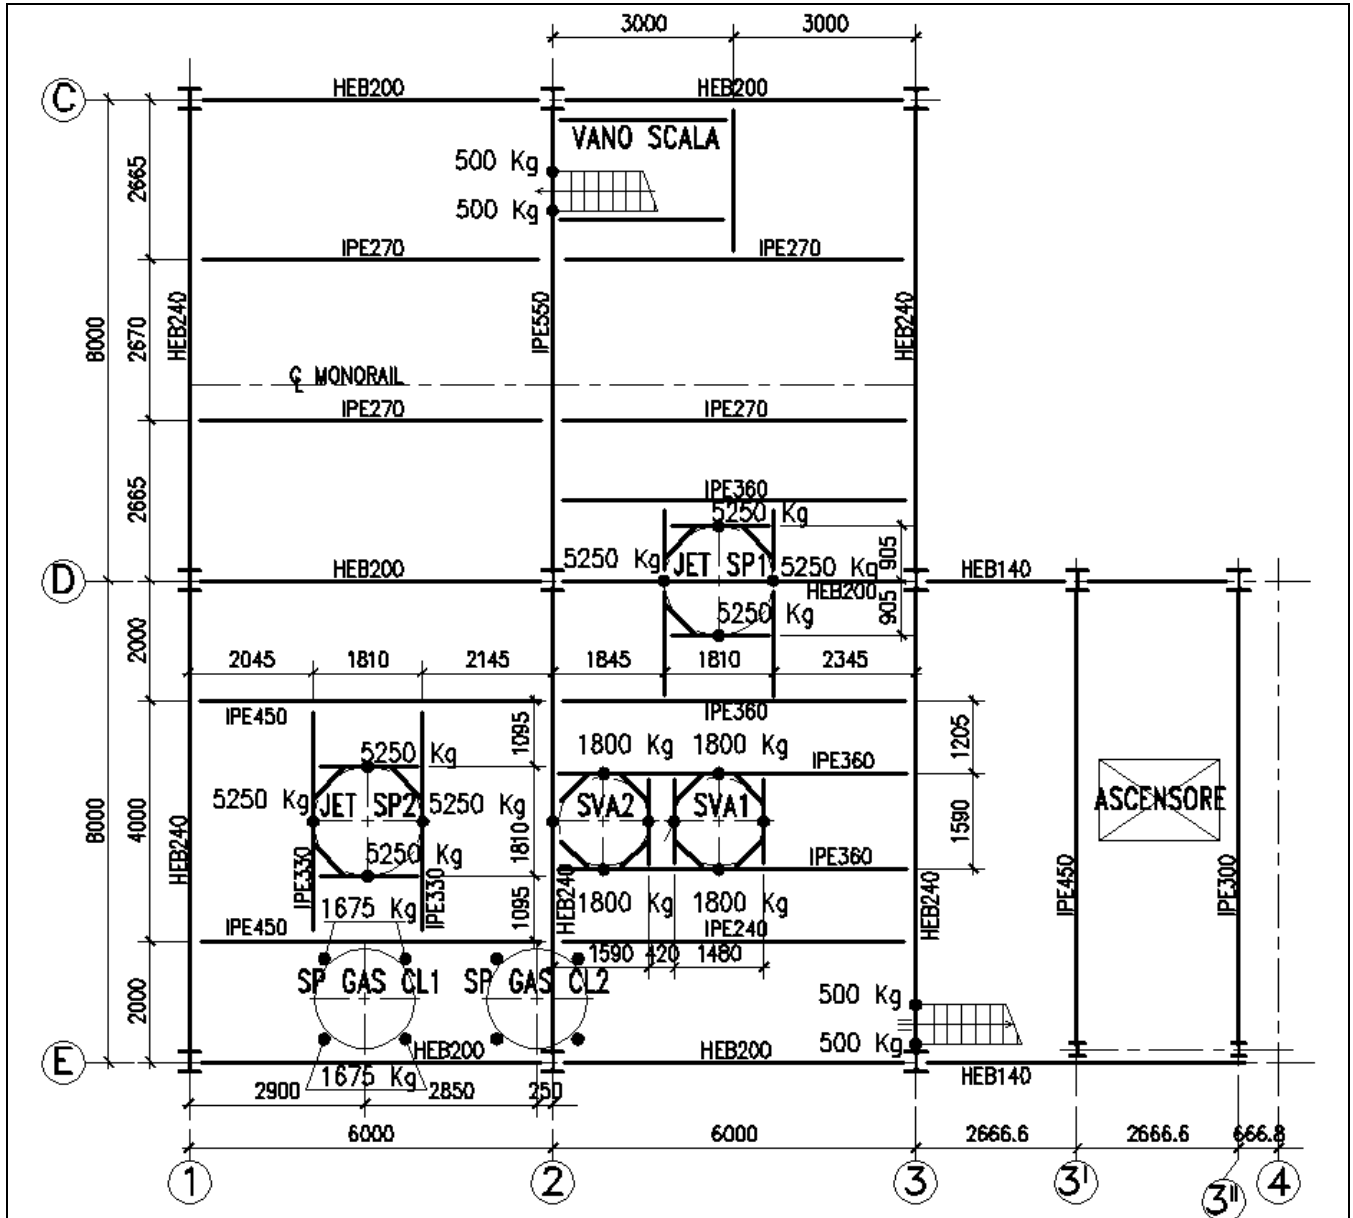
PLANIMETRIA +30.800 - sesto impalcato -
